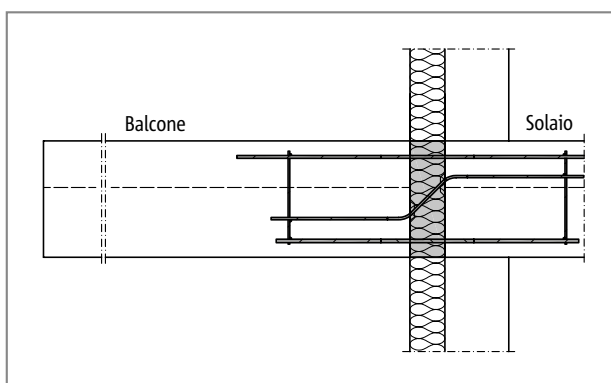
Schöck Isokorb® tipo SXT: balcone con travi a sbalzo
